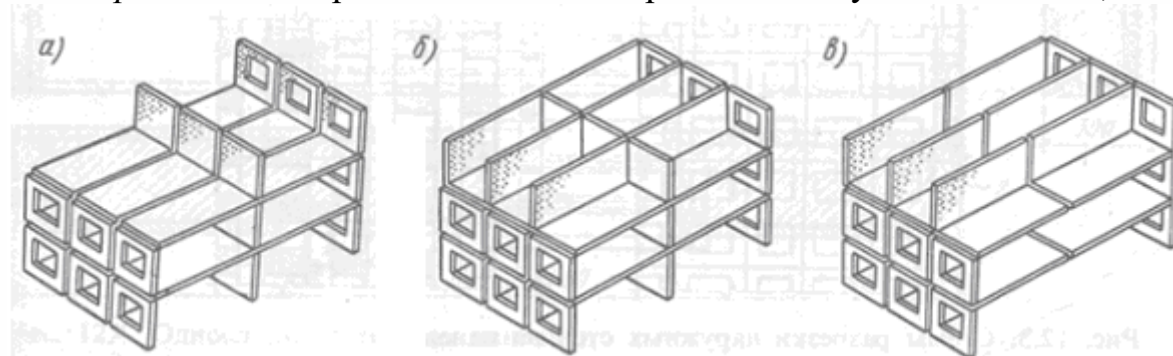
Конструктивные схемы бескаркасных крупнопанельных зданий
